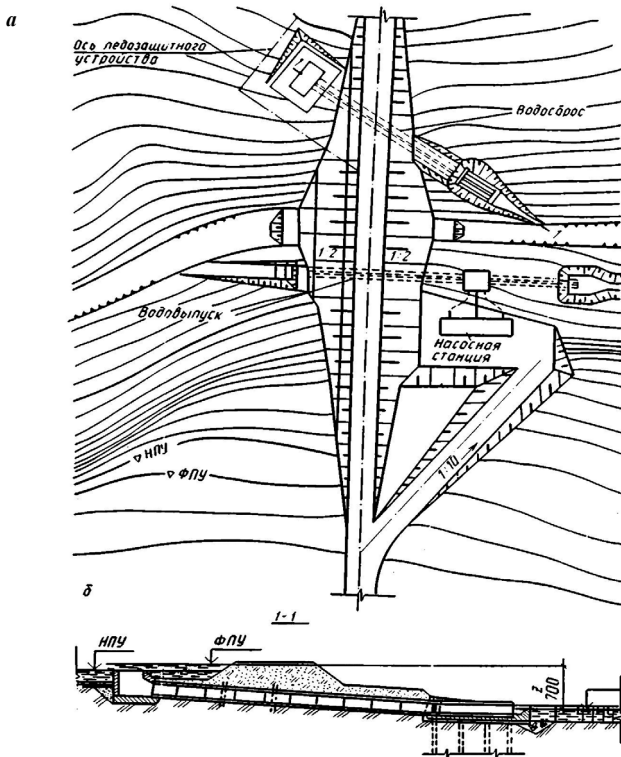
Схема гидроузла с ковшевым водобросом:
